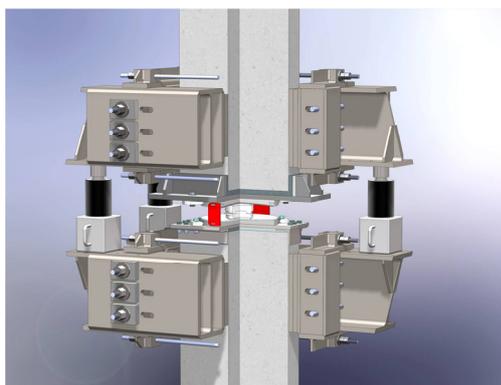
Inserimento di un isolatore sismico in un pilastro in calcestruzzo armato, previo trasferimento del carico verticale mediante morse in acciaio
